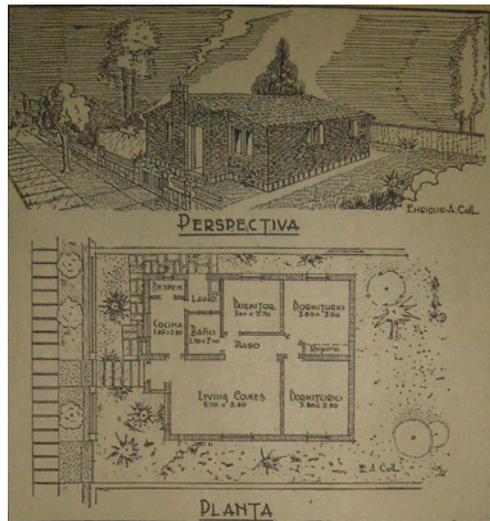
Figura IV: Vista y planta de la ampliación del barrio "4 de junio. Los Andes, 22 de abril de 1948, p. 5 / Perspectiva del barrio. Fuente: AHM
